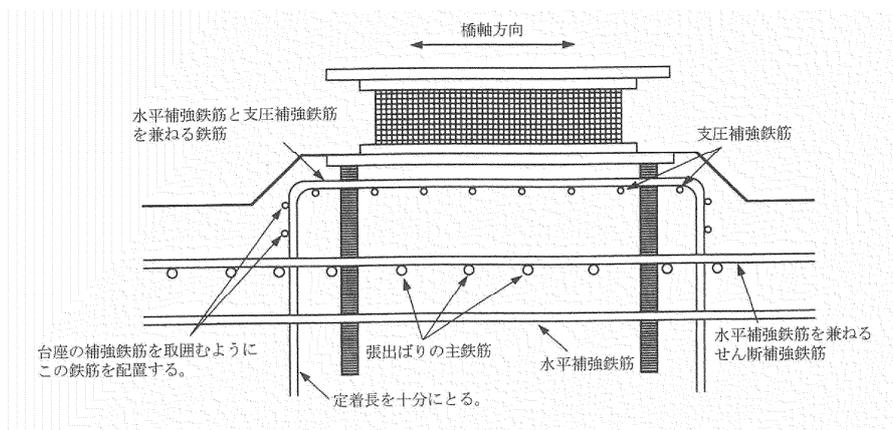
台座がある場合の橋座部の配筋例（橋脚張出部に設置した場合）
